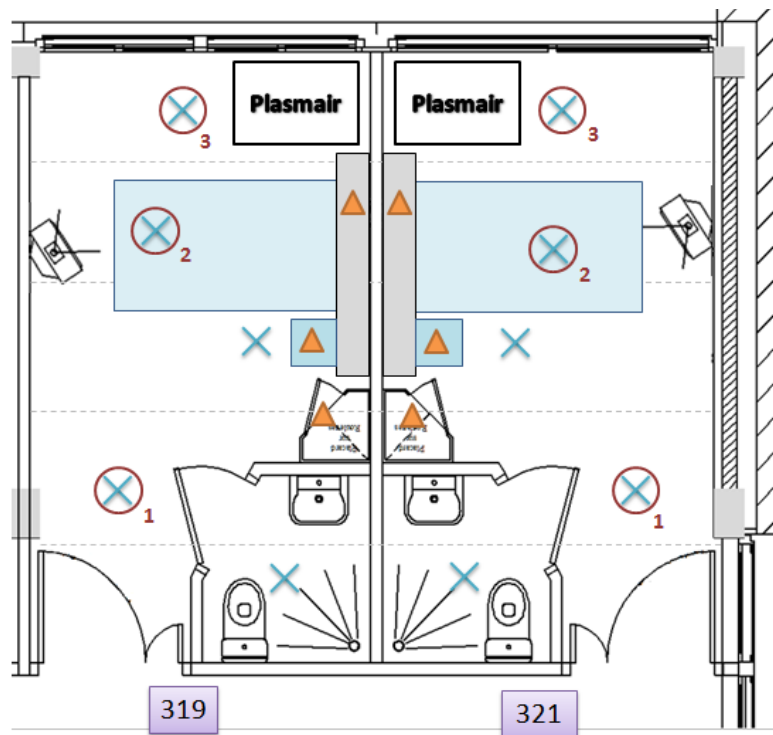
Plan prélèvement des chambres équipées de Plasmair
